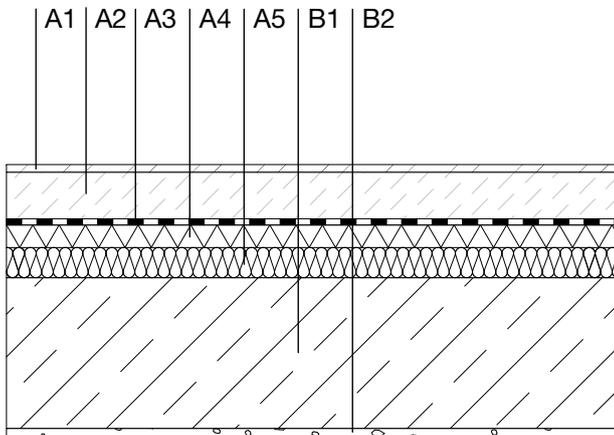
Vertikalschnitt Geschossdeckenaufbau DE1, M 1:10
